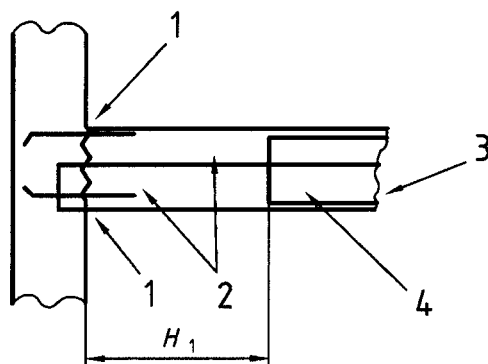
exemple de cas de poutrelles parallèles à la paroi
